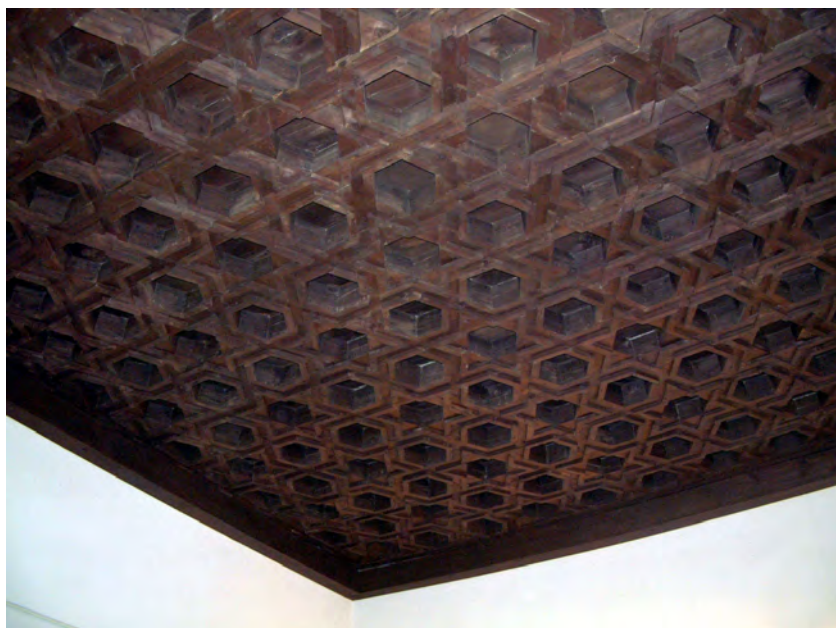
Restos de techo de lacería en un salón de la planta alta. Foto: AMTS
